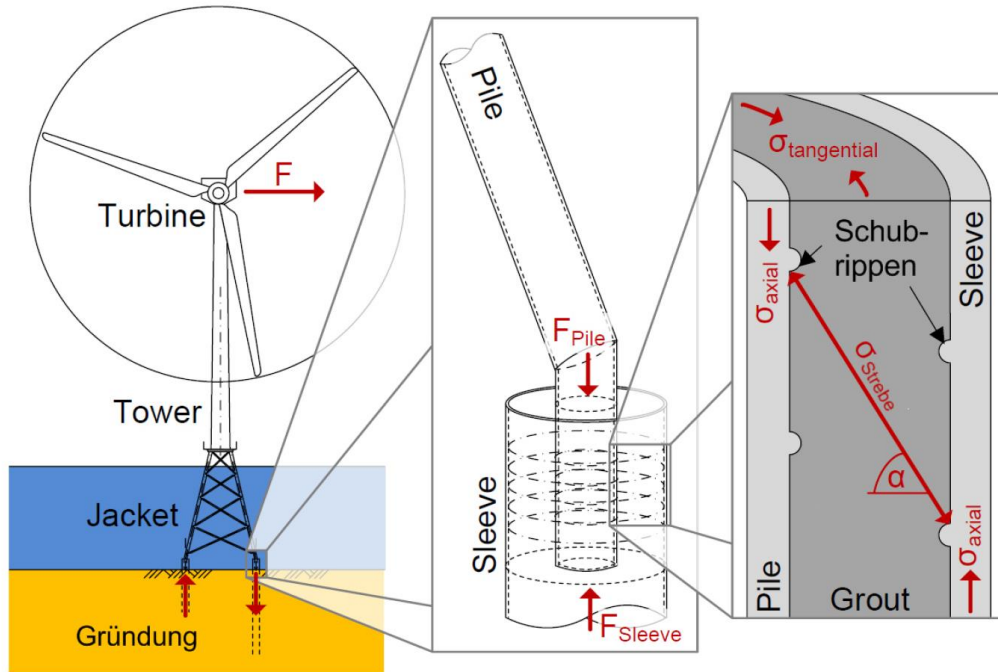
Lastabtrag einer Jacket-Tragstruktur bzgl. Windbelastung (links) und Detail einer Grout-Verbindung mit Schubrippen (rechts)
